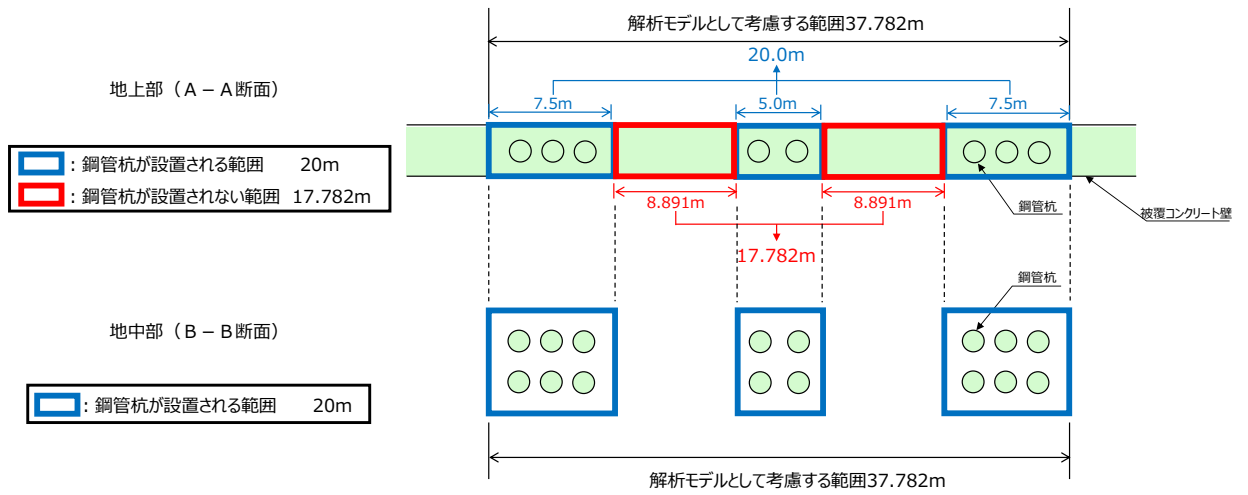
－20 防波壁（多重鋼管杭式擁壁）の④－④断面の部分を拡大した平面図
